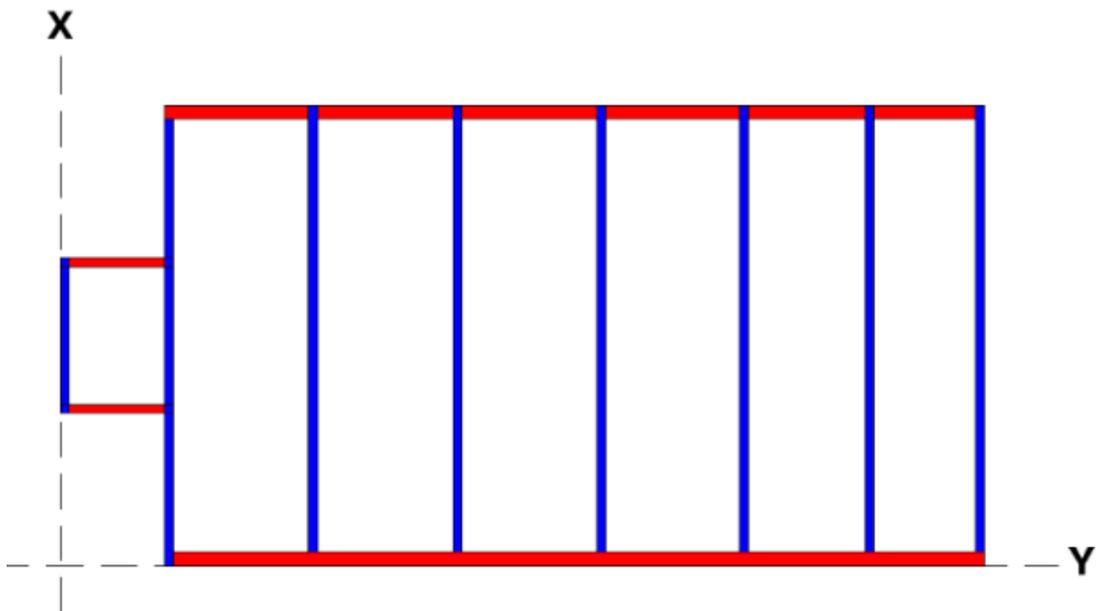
Ejes X-Y de Planta baja y alta de la biblioteca
